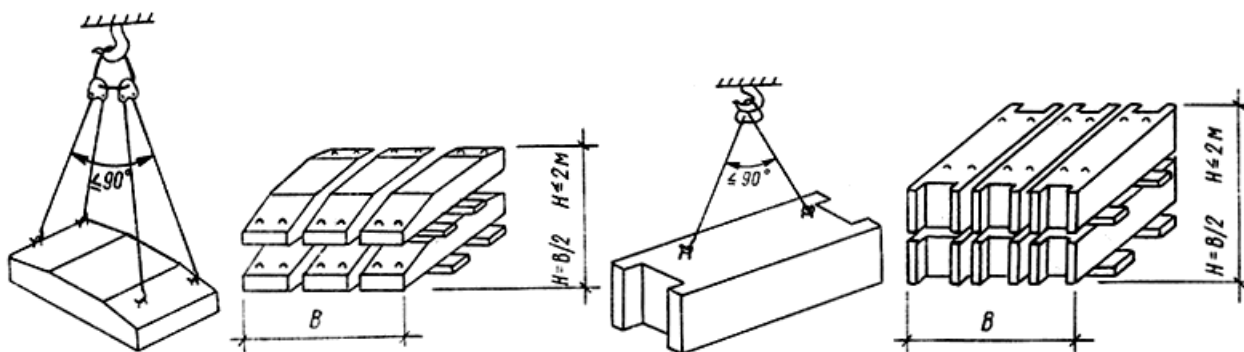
Схемы строповки и складирования фундаментных плит и стеновых фундаментных блоков
